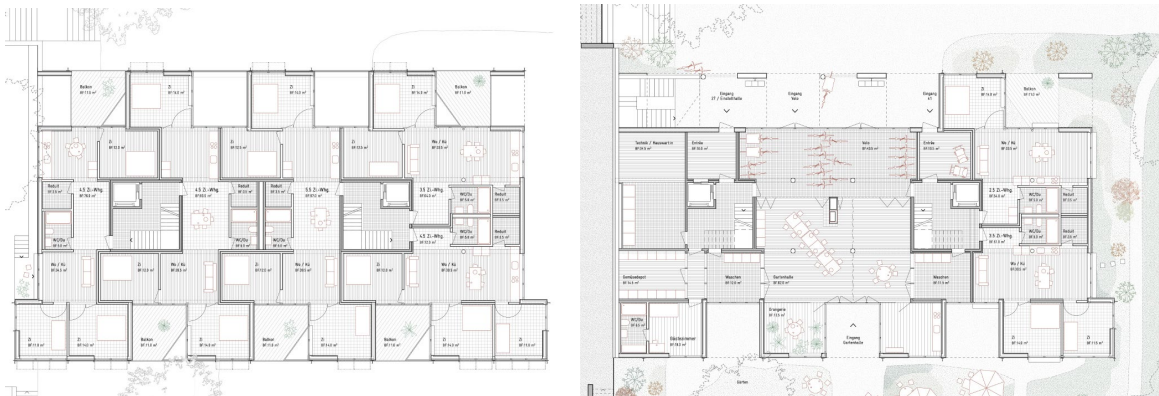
Grundrisse Gassengeschoss (links) und Gartengeschoss (rechts), ohne Masstab
